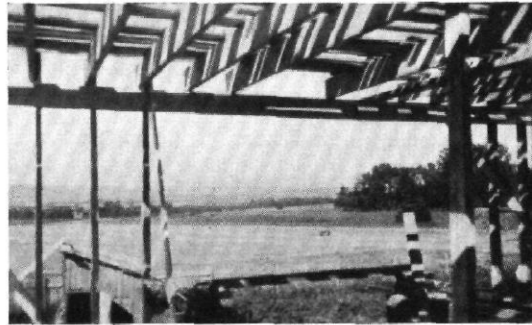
22 (hierunter) / Am anderen Tage wurde das Dach mit Ludowici-Flachziegeln eingedeckt und am selben Tage mit der Montage der Licht-Leitung begonnen, die in den Decken und Wandhöhlräumen denkbar leicht verlegt wurde. Hinter den Elektromonteuren wurden die Innen-Stiele mit Leifaplatten verkleidet, auf deren Fabrikationsmaße die Stielabstände und Geschosshöhen zugeschnitten waren. Ebenso wurden nach Verlegung der elektrischen Leitungen und Versteifung der Balken durch Kreuz-
